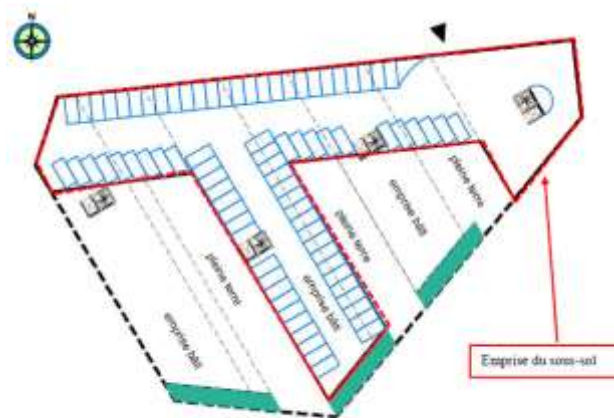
Extrait du plan prévisionnel des parkings – Niveau R-1
